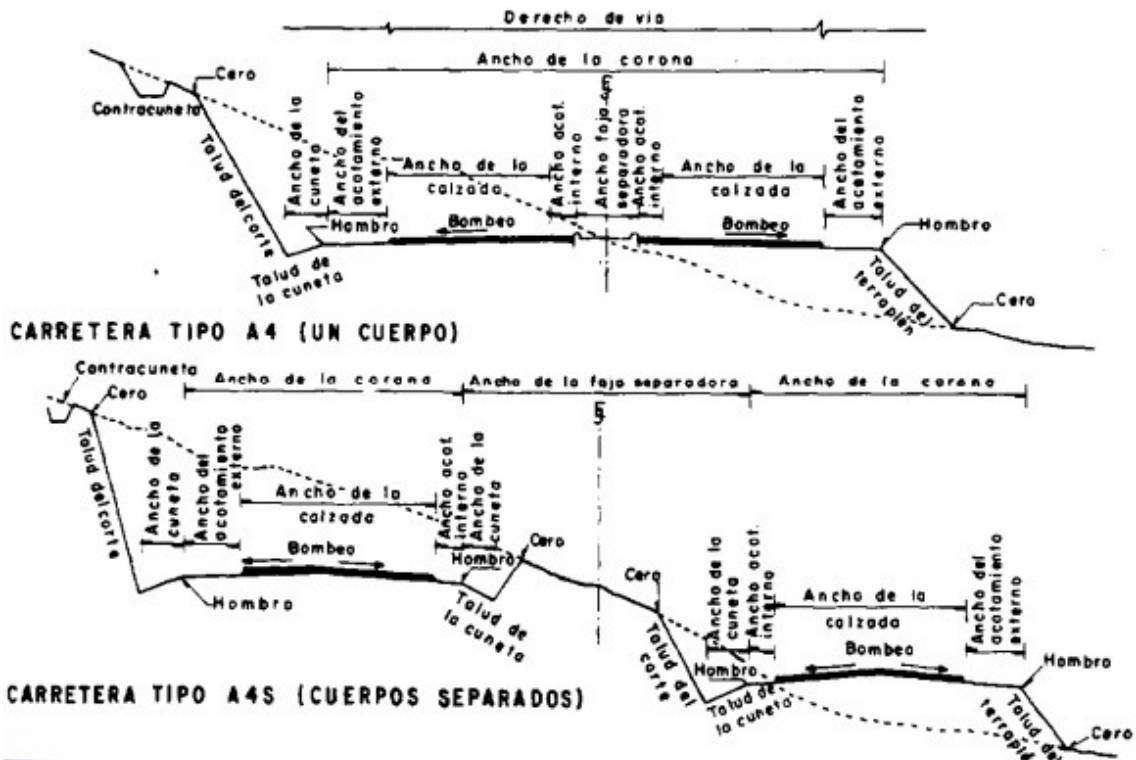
Secciones transversales, carreteras tipo: A4 por SCT
